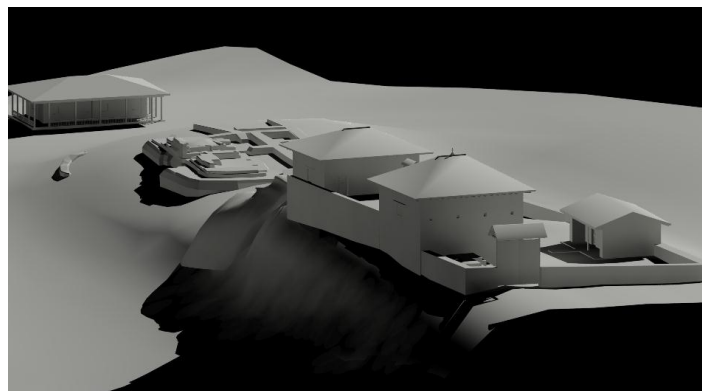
Detalles del Modelado Baños del Inca V
